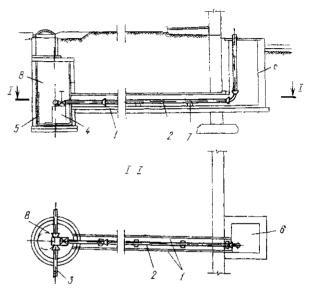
1 Вариант устройства ввода водопровода в здание при сгроительстве на просадочных грунтах
